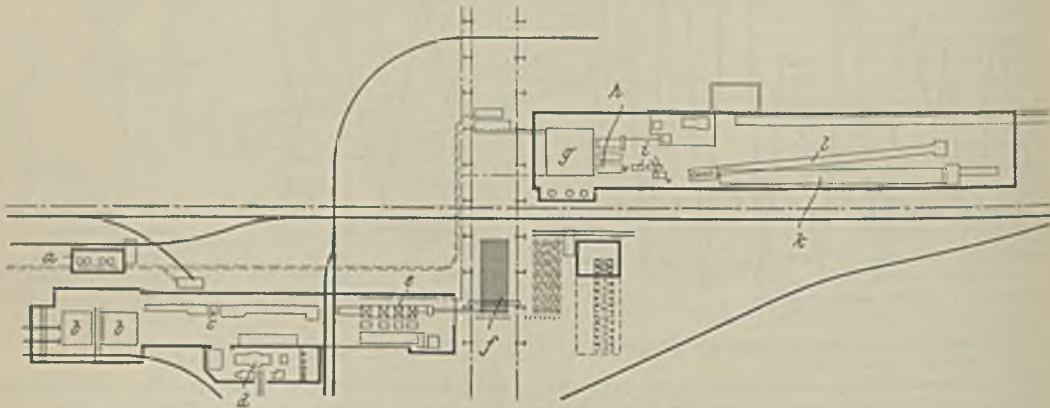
Lageplan der Walzwerksanlagen der Steel Co. of Canada.
